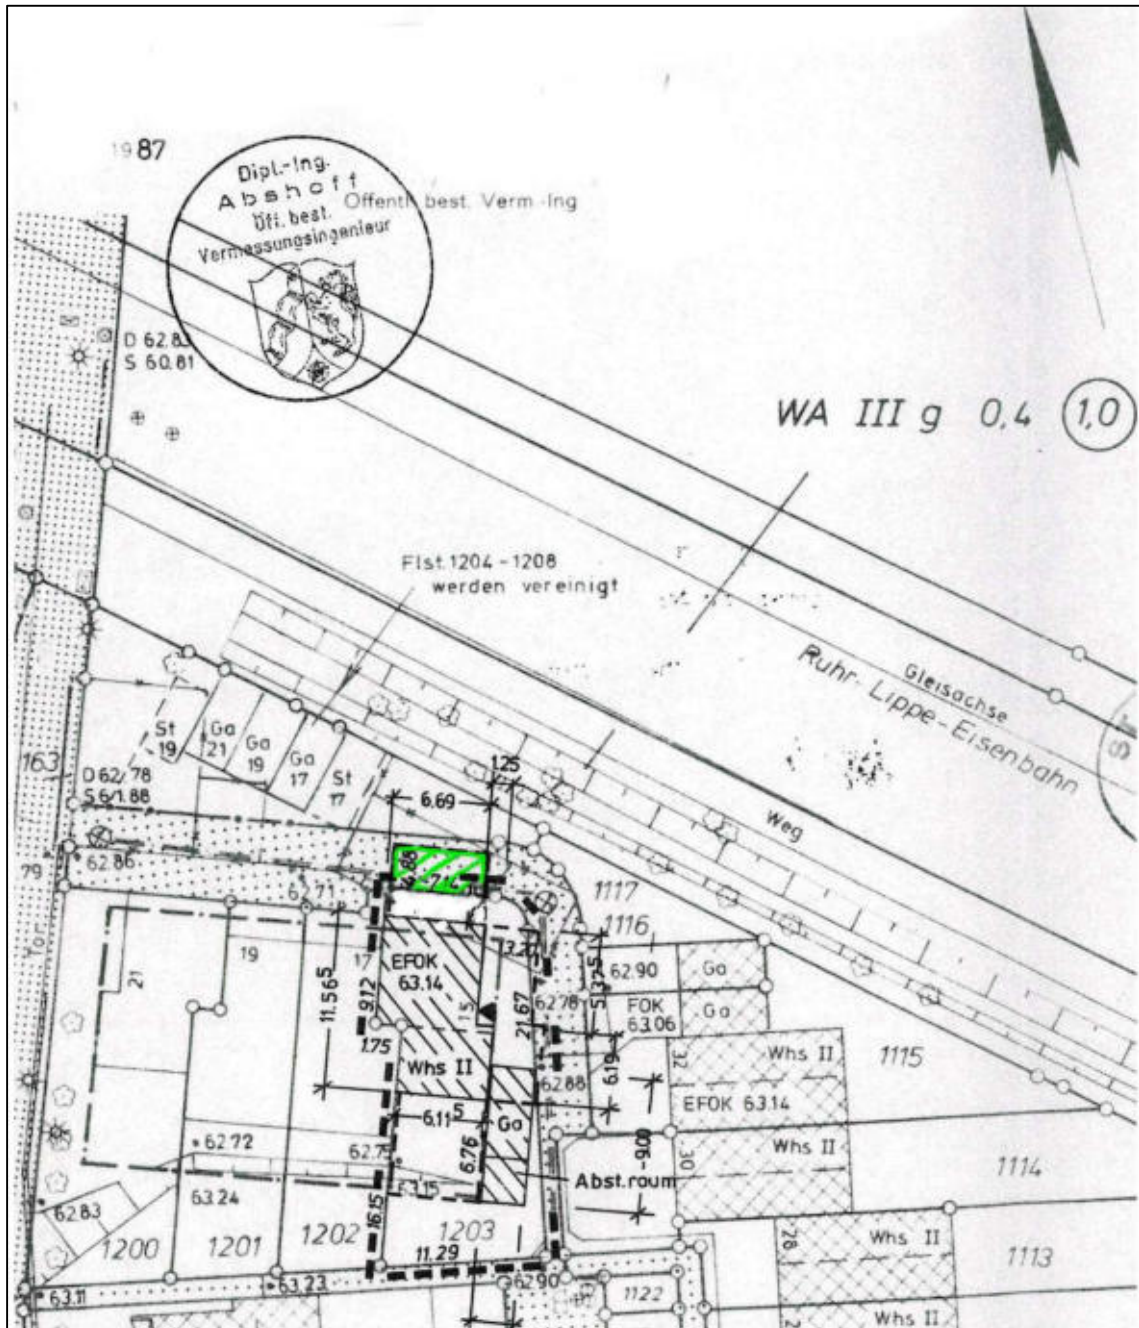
Lageplan zur Baulast lfd. Nr. 4
